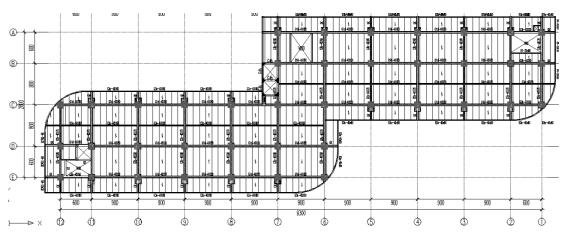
Denah Rencana Pelat Lantai 1 Modifikasi Sumber: Hasil FGD *Value Engineering
